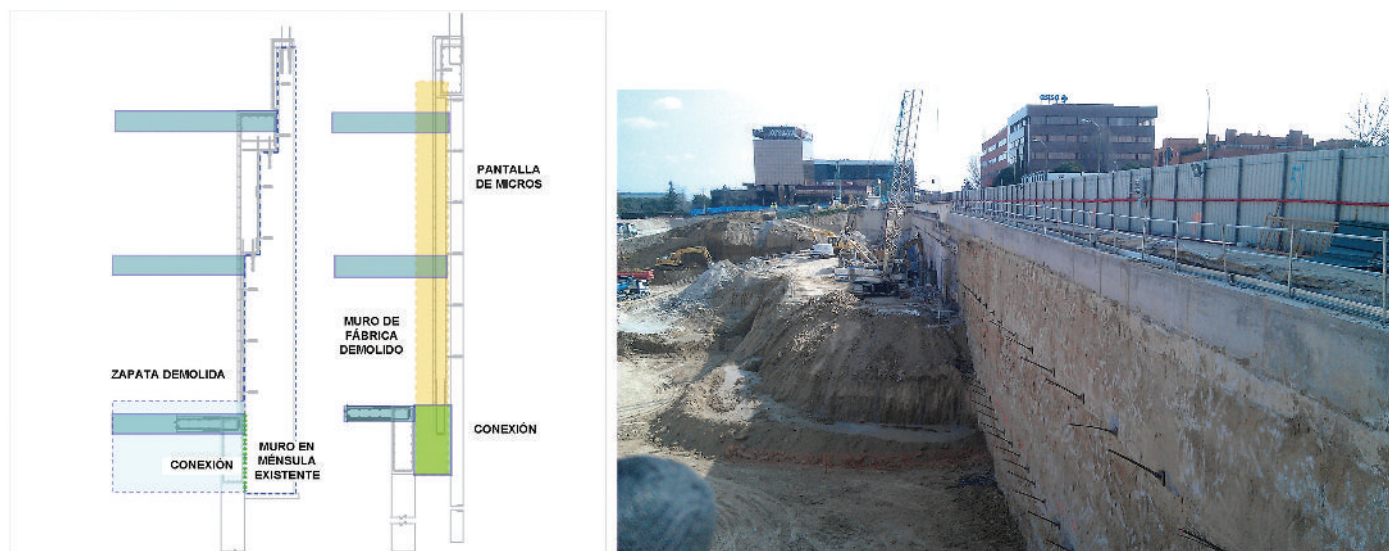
Muro de sostenimiento de la calle Luca de Tena, conectado a pantalla inferior y forro final conectado mediante llaves ancladas con resina tipo epoxi (izquierda). Imagen de la ejecución de la pantalla delantera que extiende el sostenimiento hasta la profundidad de proyecto (derecha).
